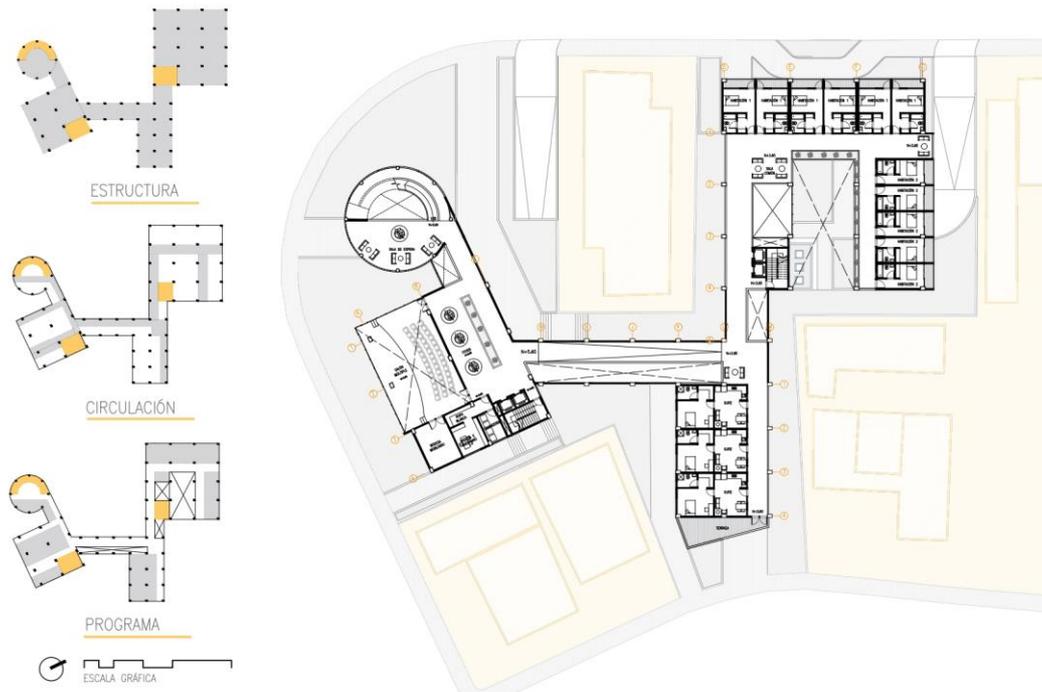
Planimetría: Planta alta 1 (N+3.60). Elaboración propia.
